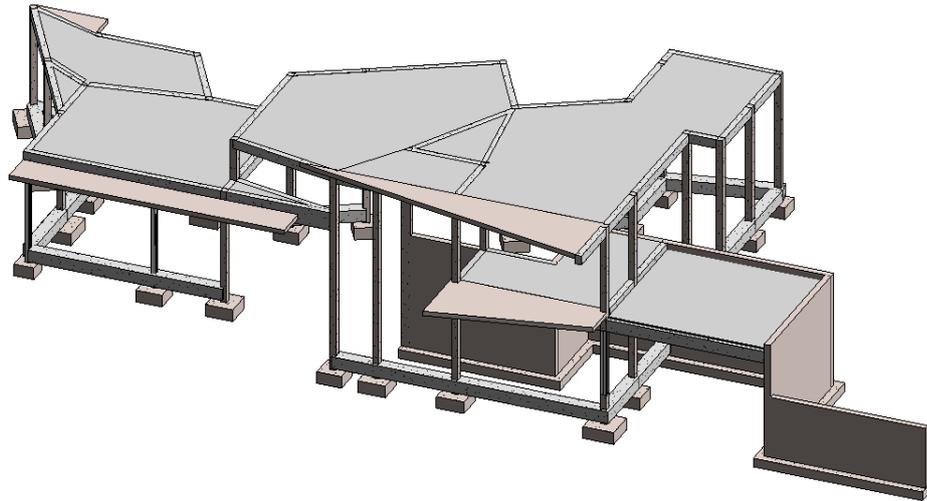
Modelo de estruturas da habitação em estudo completo
